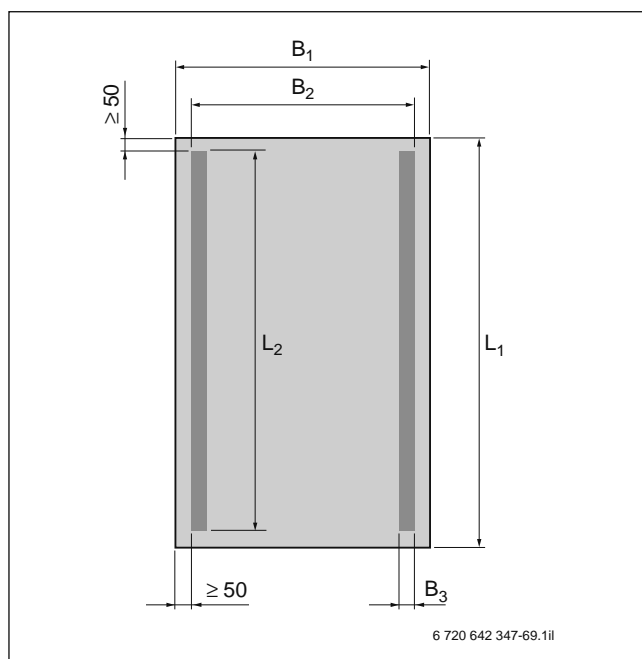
Фундамент для отопительных котлов UNIMAT UT-L
